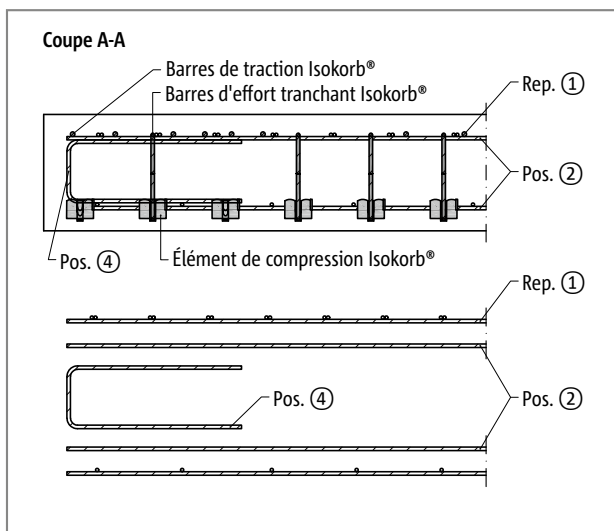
Schöck Isokorb® T Type K-E, K-T : Renforcement sur site du côté balcon pour la coupe AA ; Pos.4 = bordure constructive sur bord libre perpendiculaire à l'élément Schöck Isokorb®
